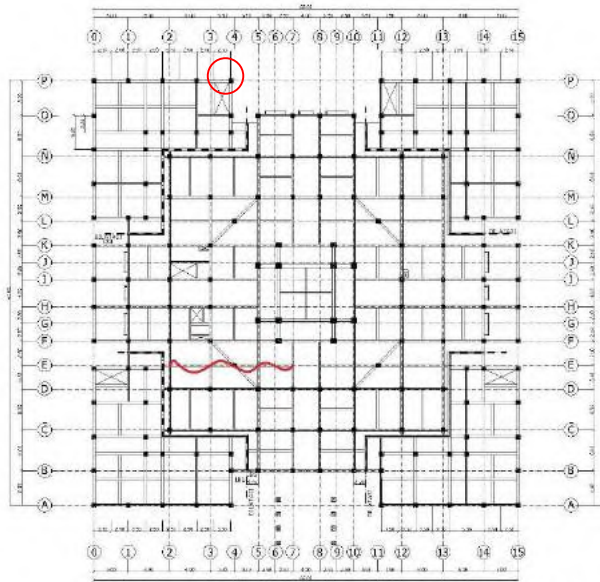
Analisa Hubungan Balok Kolom Interior
